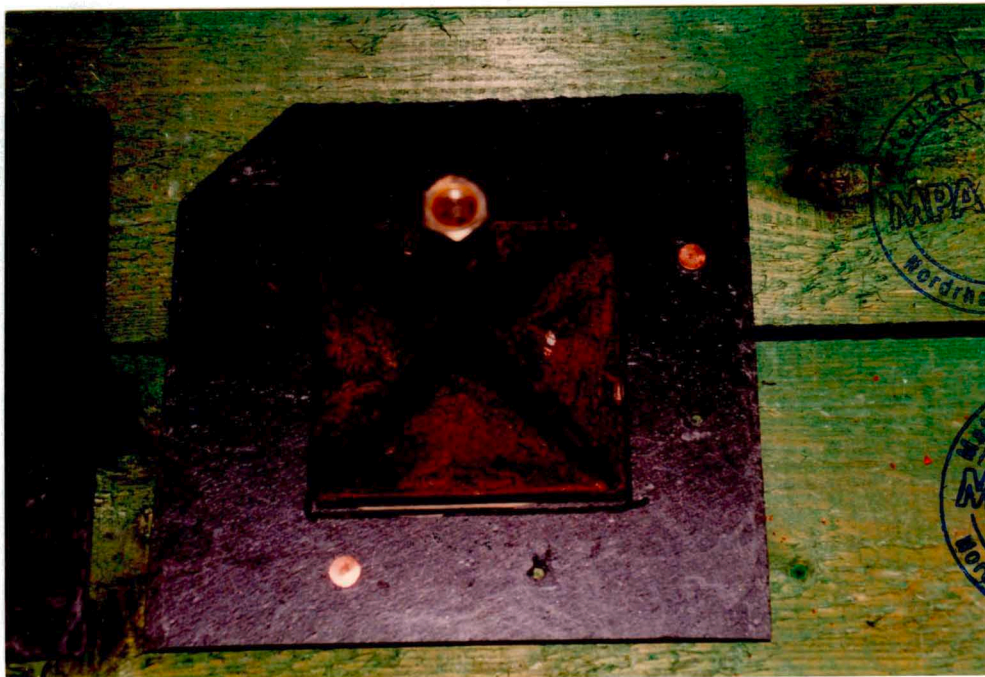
Schieferplatte mit 2 Kupfernägeln auf Brettern befestigt. Lochdurchmesser in der Platte = ca. 3 mm.
